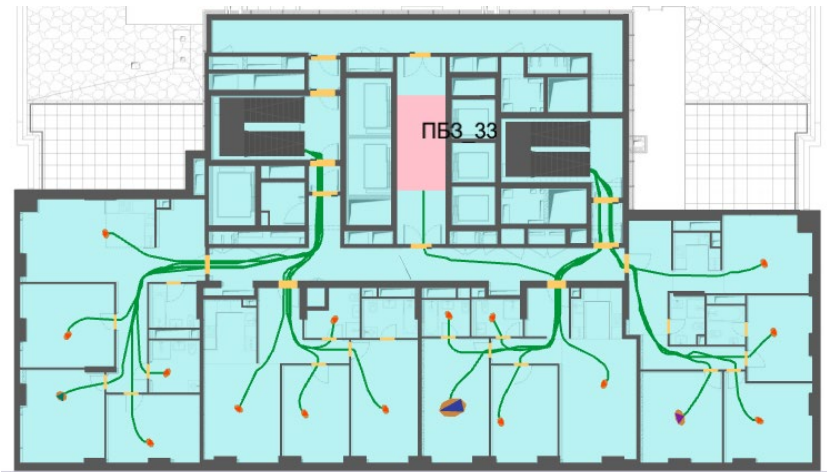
План 33-го этажа и нанесенная на него расчетная (принципиальная) схема эвакуации
